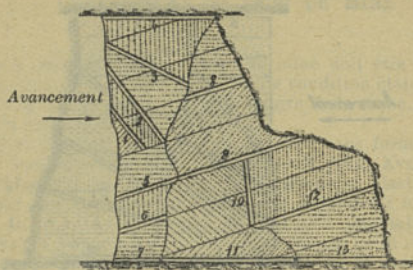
Banes pris par le toit (coupe longitudinale).
